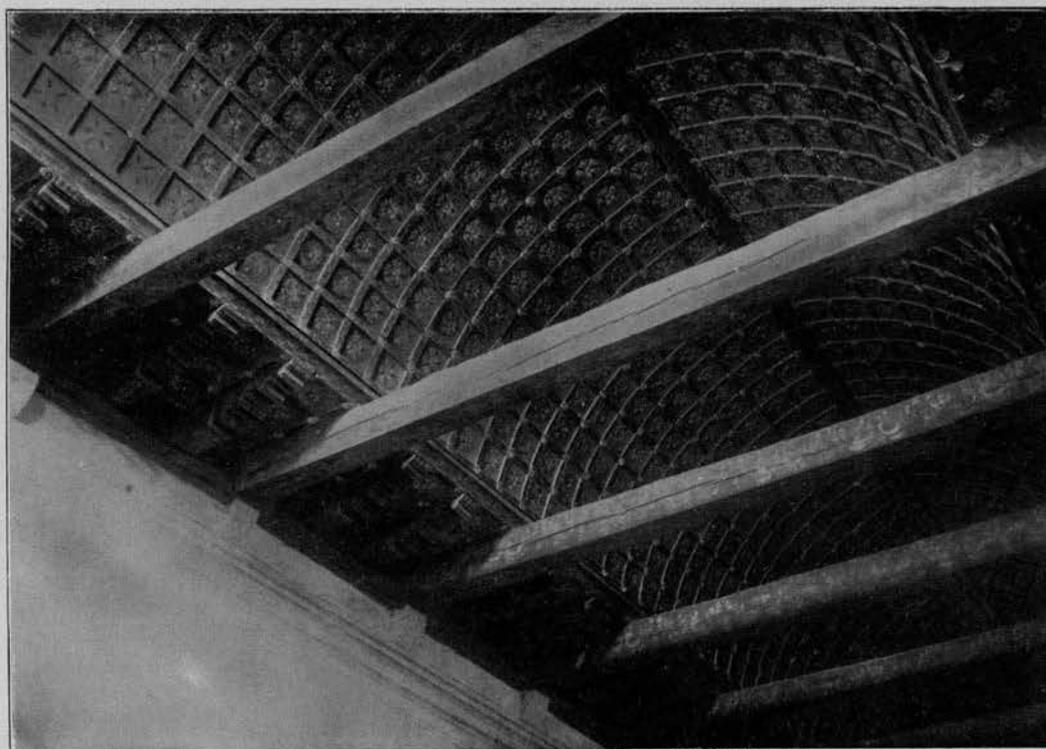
S. Giacomo dall'Orio. Soffitto dopo il restauro.
